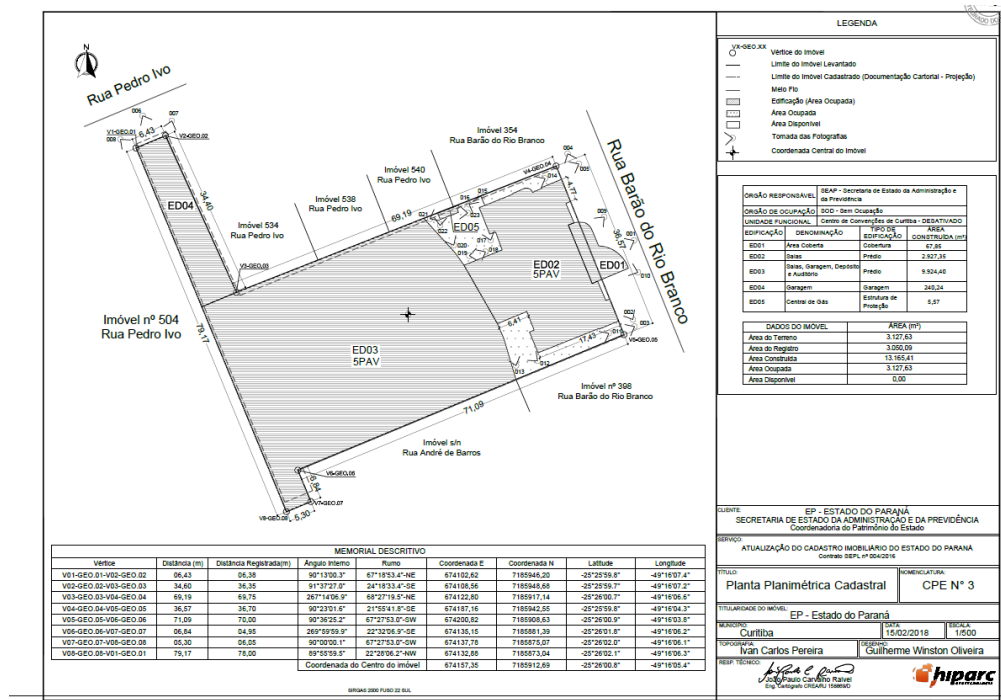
Planta Planimétrica Cadastral, incluída no Processo 15.344.637-7 (Termo de cessão para a UNESPAR)
